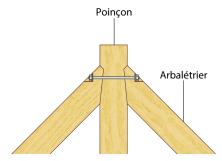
Exemple d'assemblage poinçon-arbalétrier par un boulon
